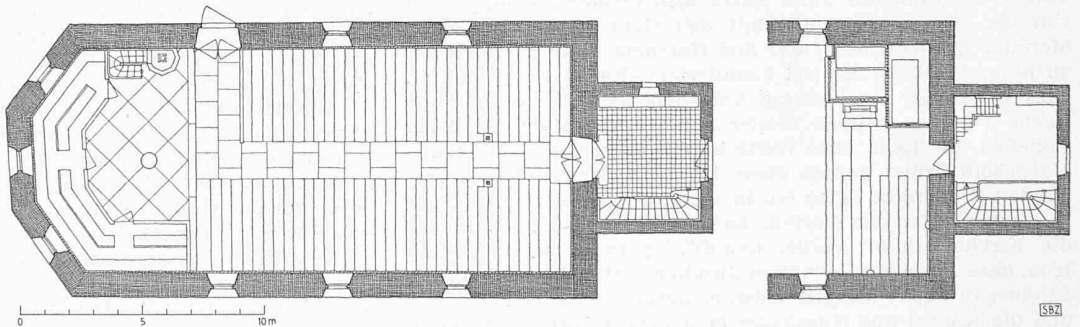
Kirchlein Wollishofen, Grundriss 1:300 (rechts Empore) nach der Renovation
